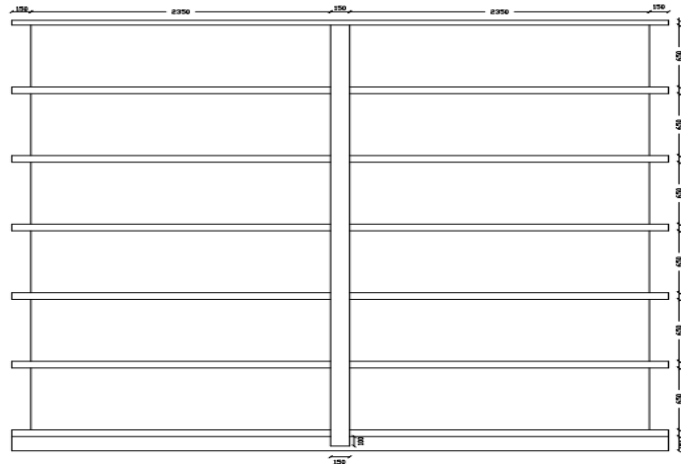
Planos de la vista en planta y transversal de la losa de cimentación.
